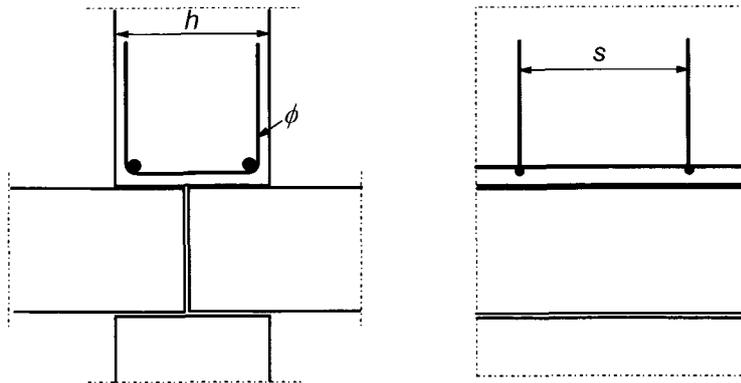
Beispiel zur Bewehrung einer Wand über der Verbindung zweier Deckenplatten
